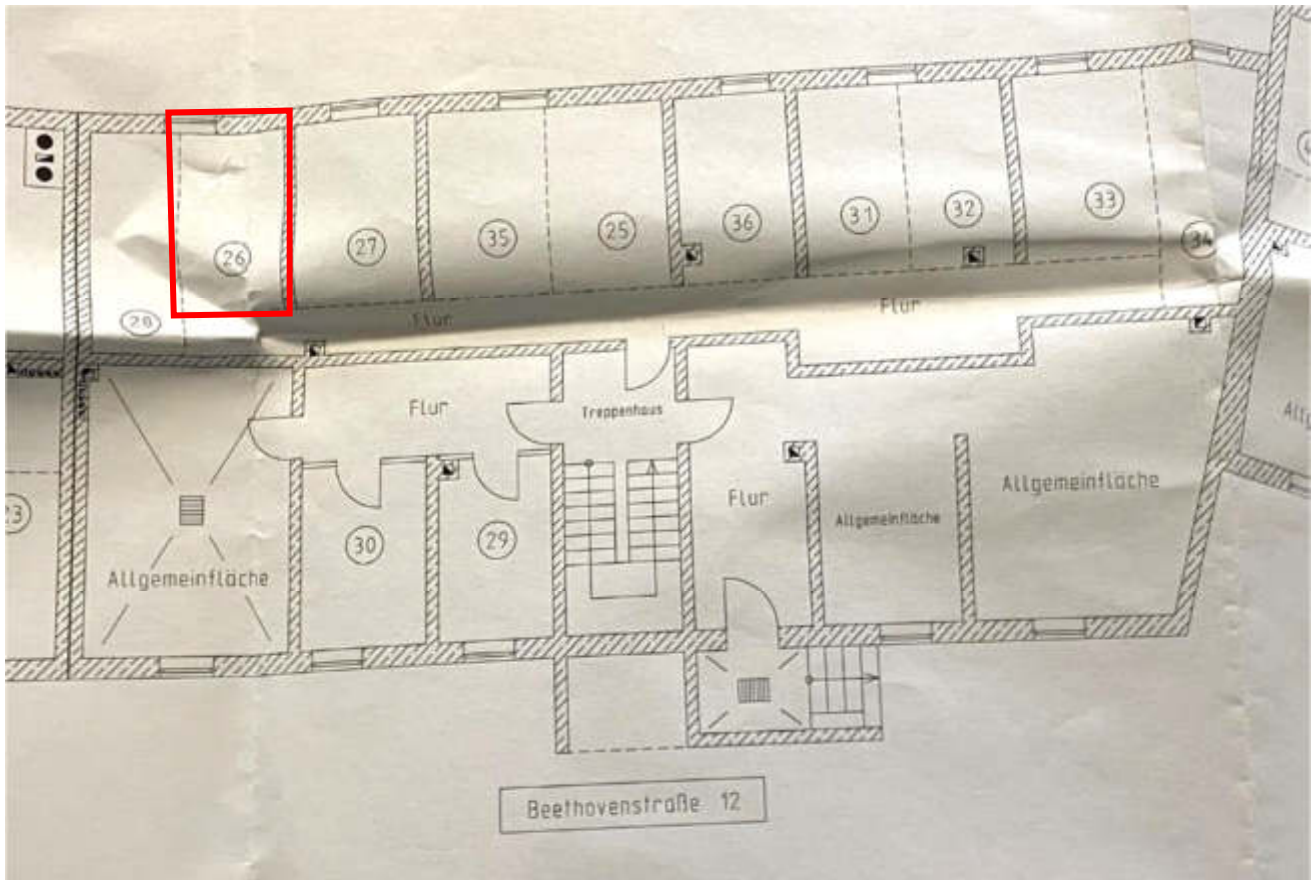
Grundriss Kellergeschoss Beethovenstraße 12 (ohne Maßstab); Detail Kellerabteil zu Wohnung 26; Quelle: Teilungserklärung vom 04.10.2001, Aufteilungspläne; Roteintragung durch den SV
